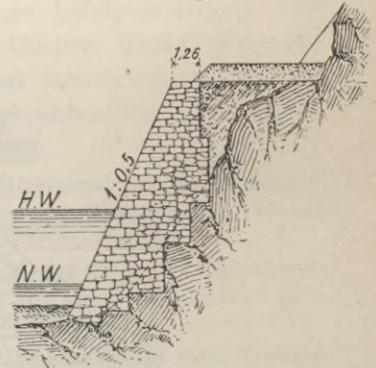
Wagerechte abgetreppte Schichten mit stufenförmigem Anschluss.
